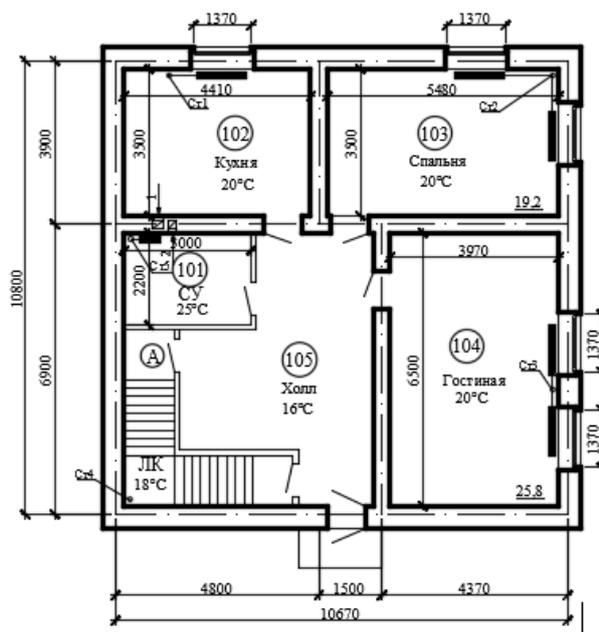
План первого этажа двухэтажного жилого дома
